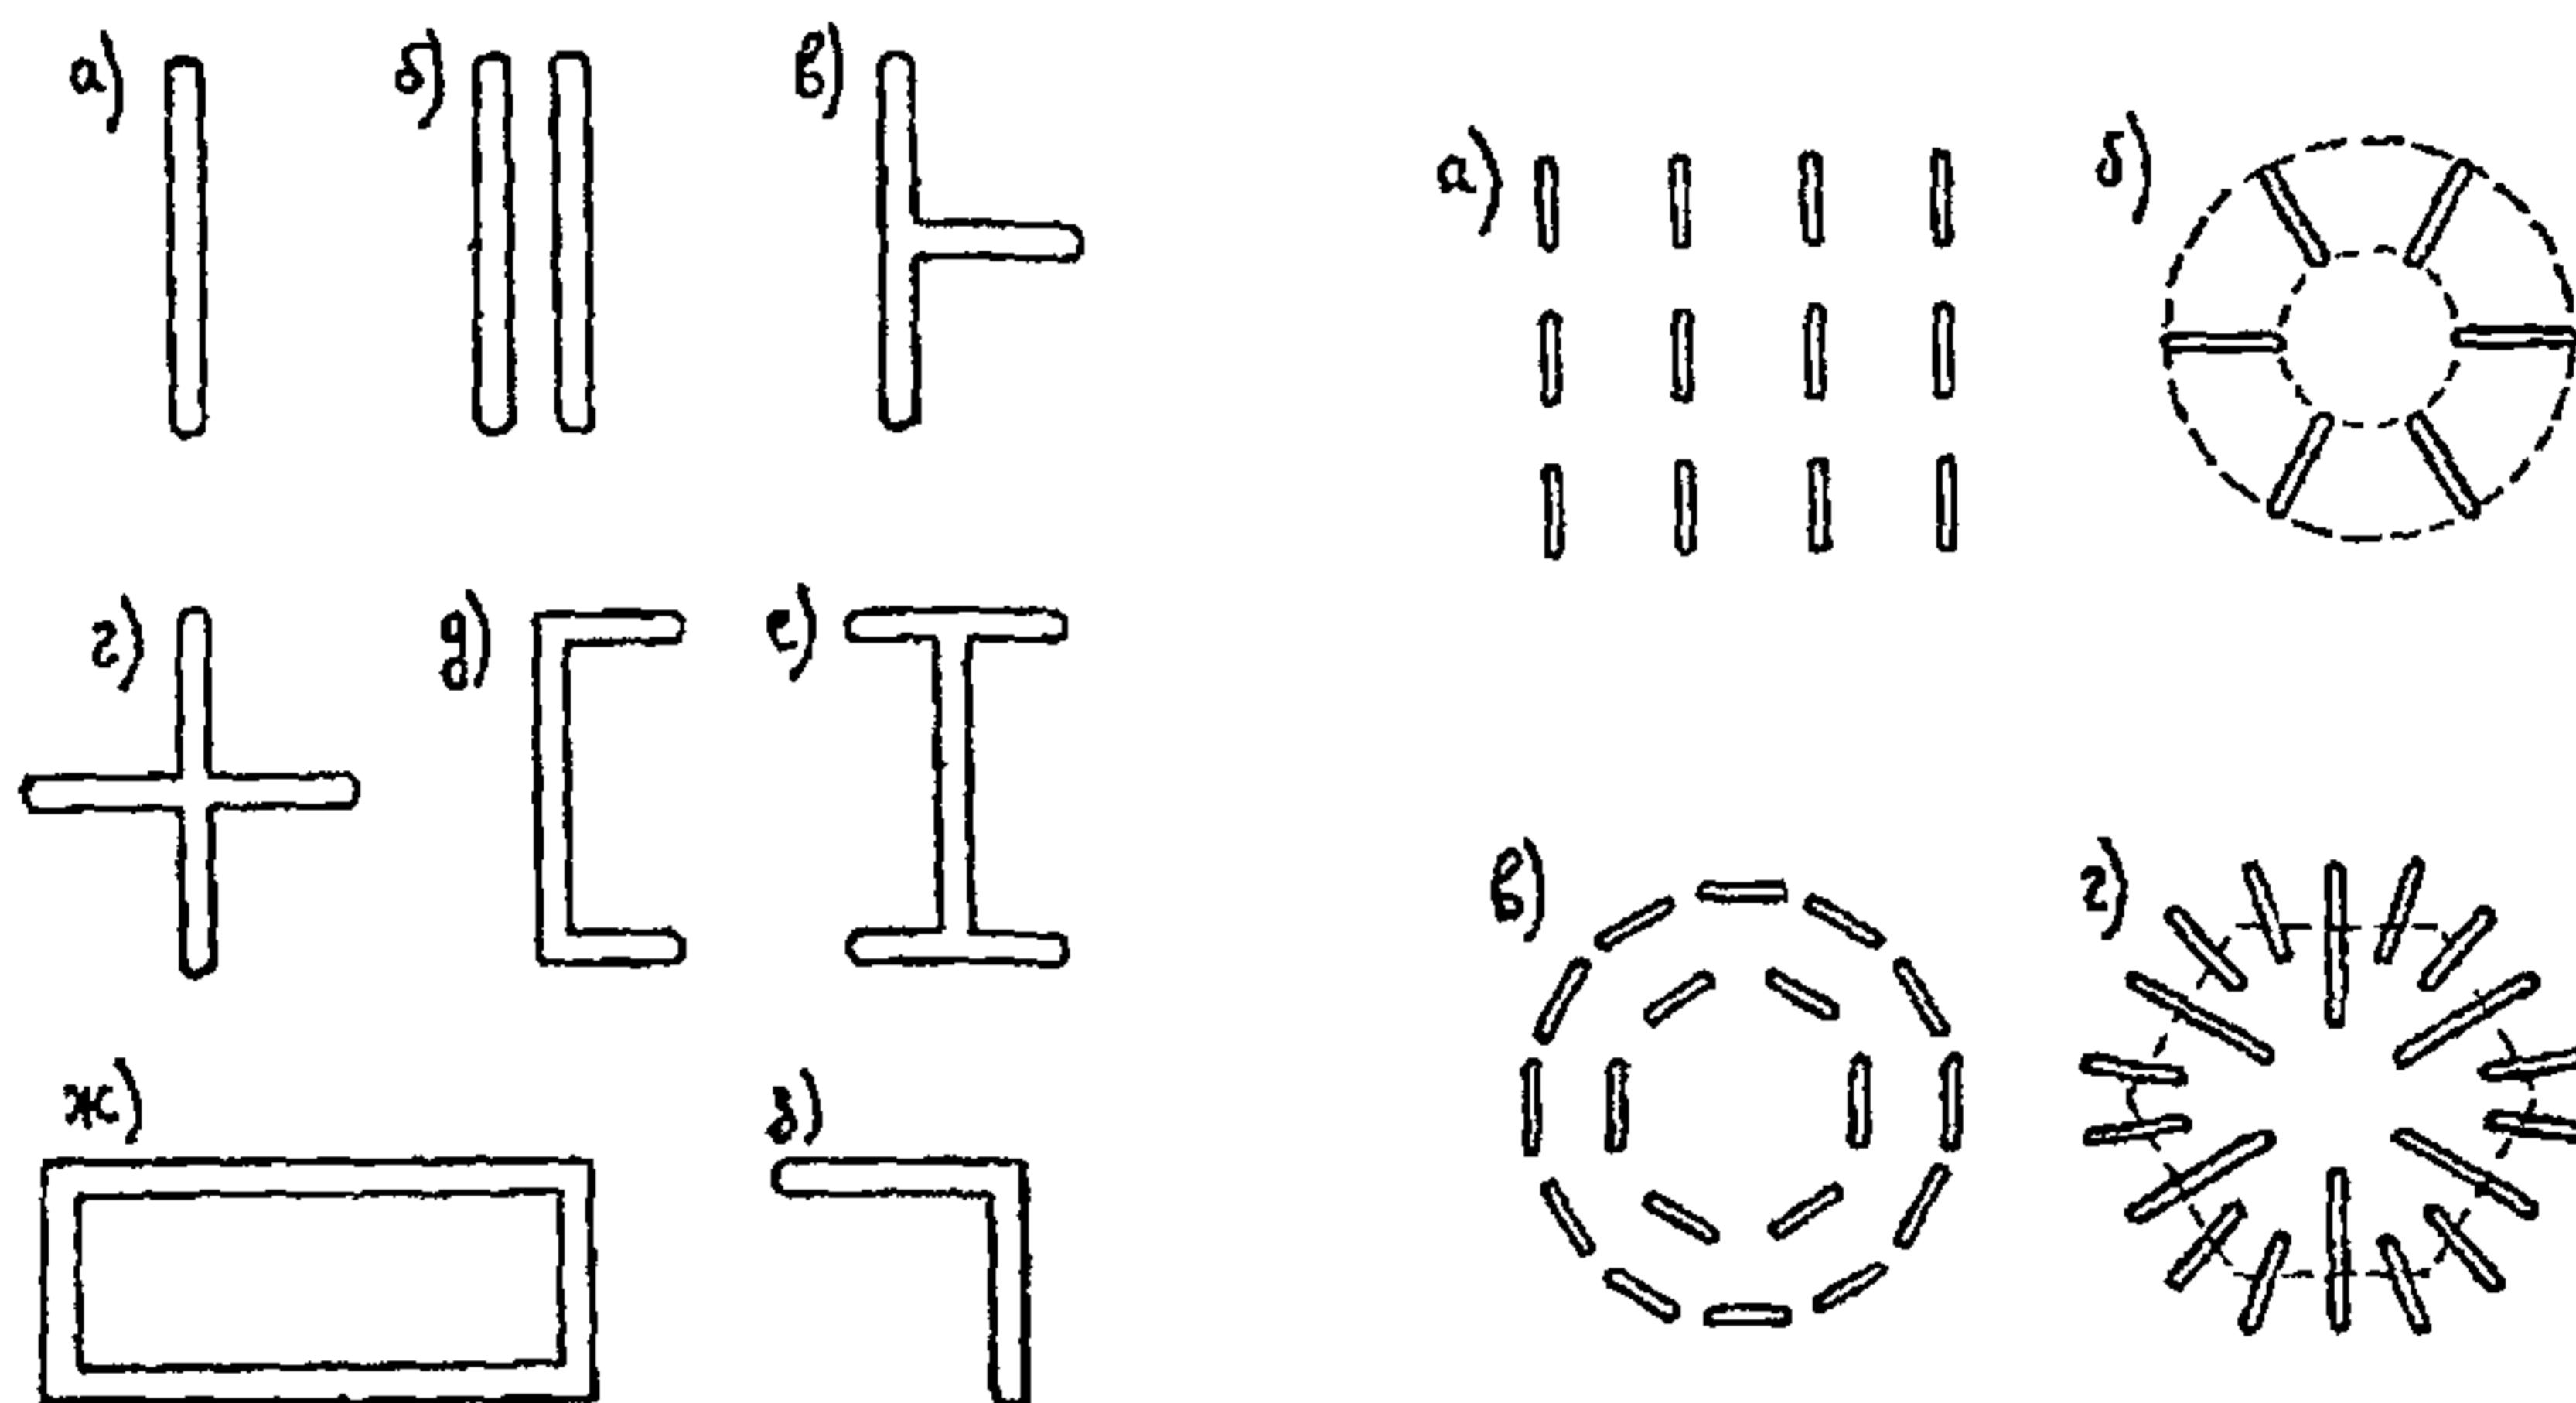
Поперечные сечения щелевых фундаментов: а - прямоугольное; б - прямоугольное сдвоенное; в - корытообразное; г - двутавровое; ж - коробчатое; з - уголковое
